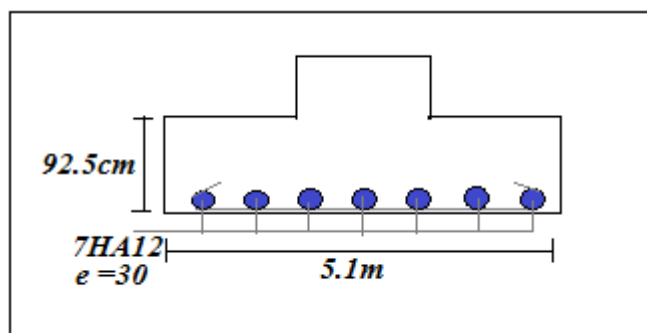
Ferrailage de semelle filante sens x-x.
